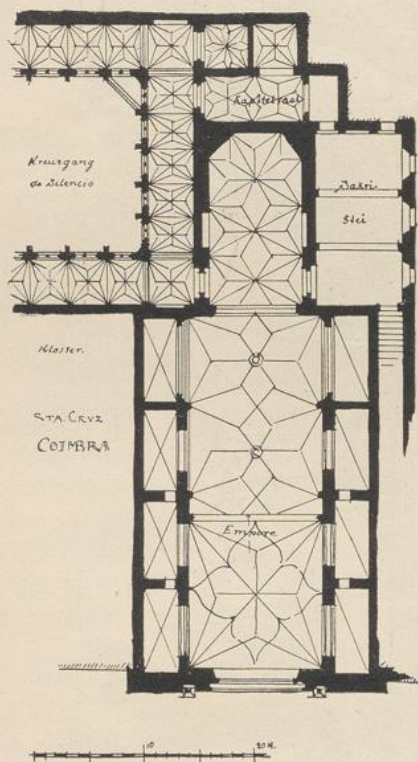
Grundriss von Sta. Cruz zu Coimbra.
